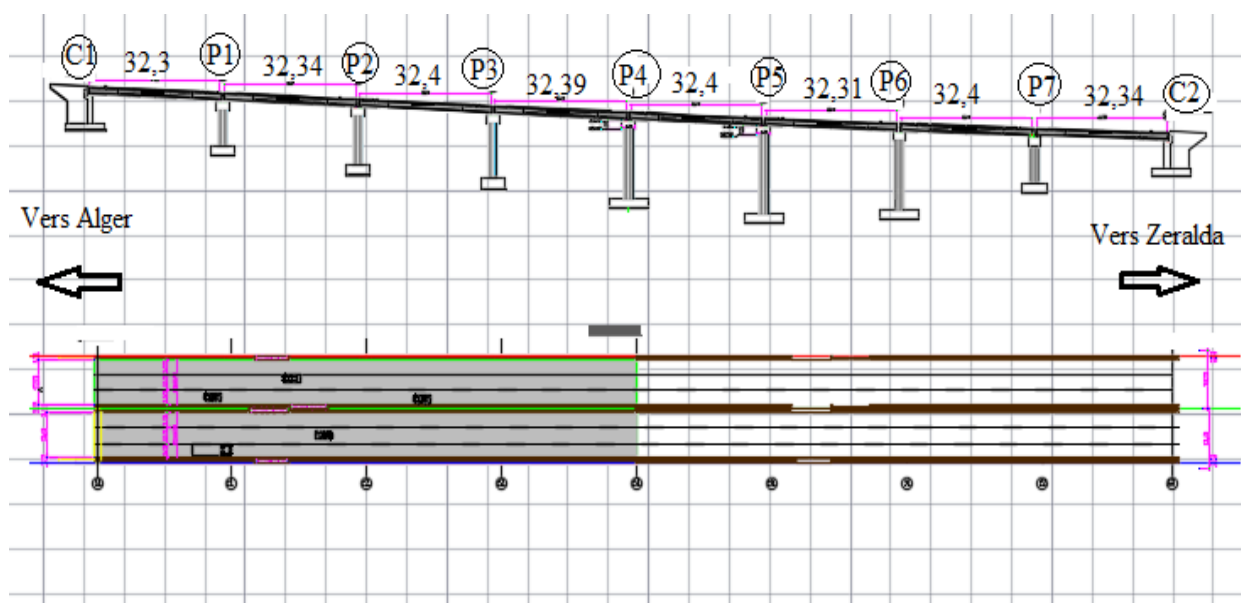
Coupe longitudinale et le tracé en plan de la 3<sup>ème</sup> variante
